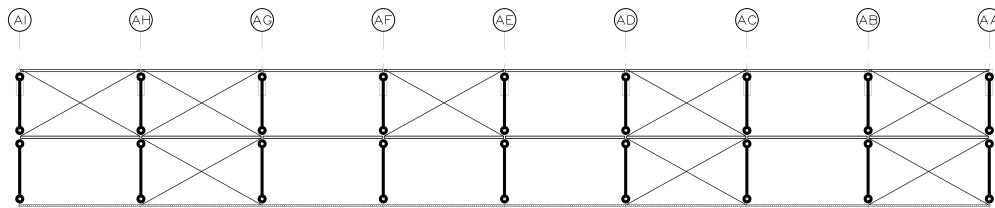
Rótulas plásticas en columnas - Análisis Dirección Y
